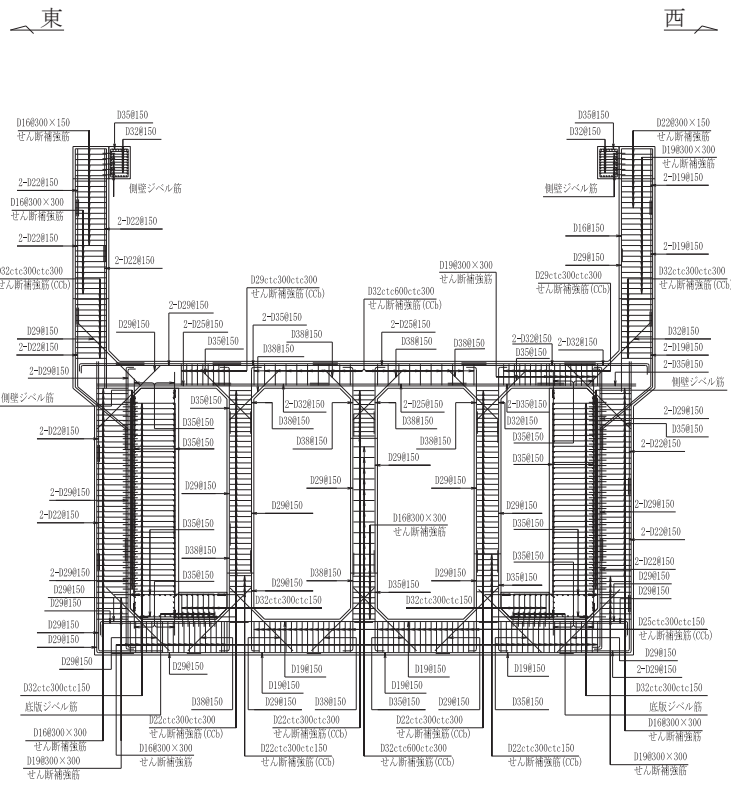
海水ポンプ室概略配筋図 (B-B 断面)
